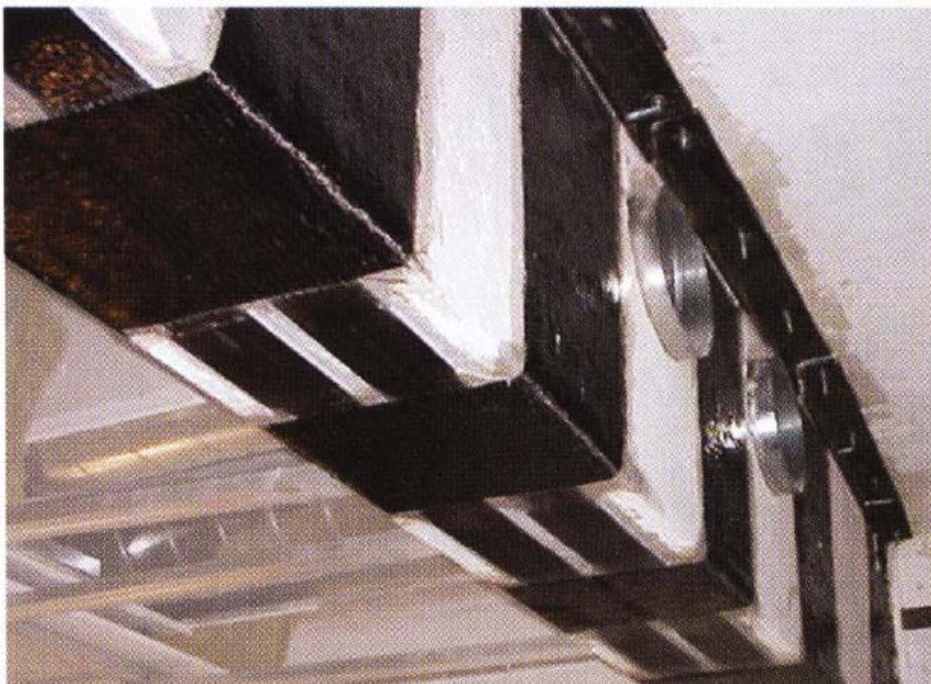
Залепване на усиляващи ленти като допълнителна надлъжна армировка
